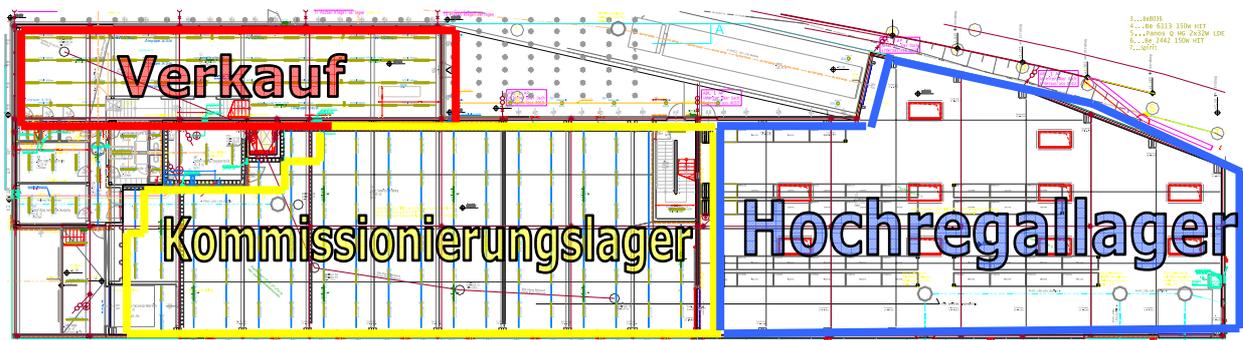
Grundriss EG - Passivbürogebäude und Kommissionierungslager „Eine Welt Handel AG“ [Pope*Prehal Architekten]
